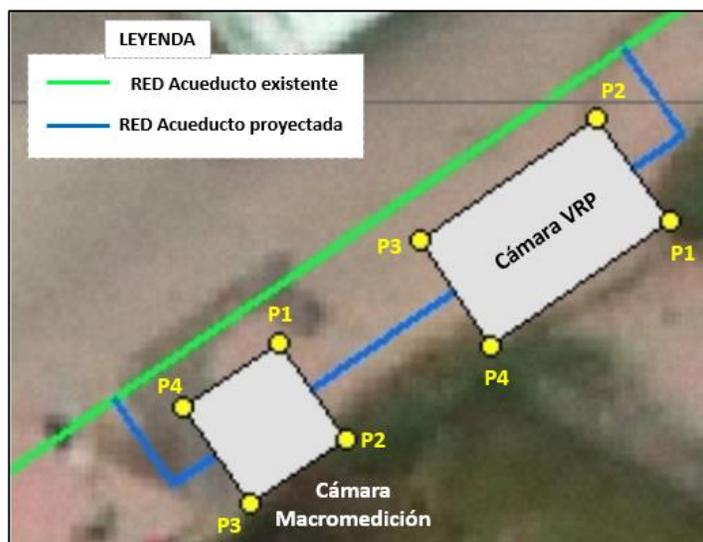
Esquema localización de cámaras proyecto. Fuente: Elaboración propia
